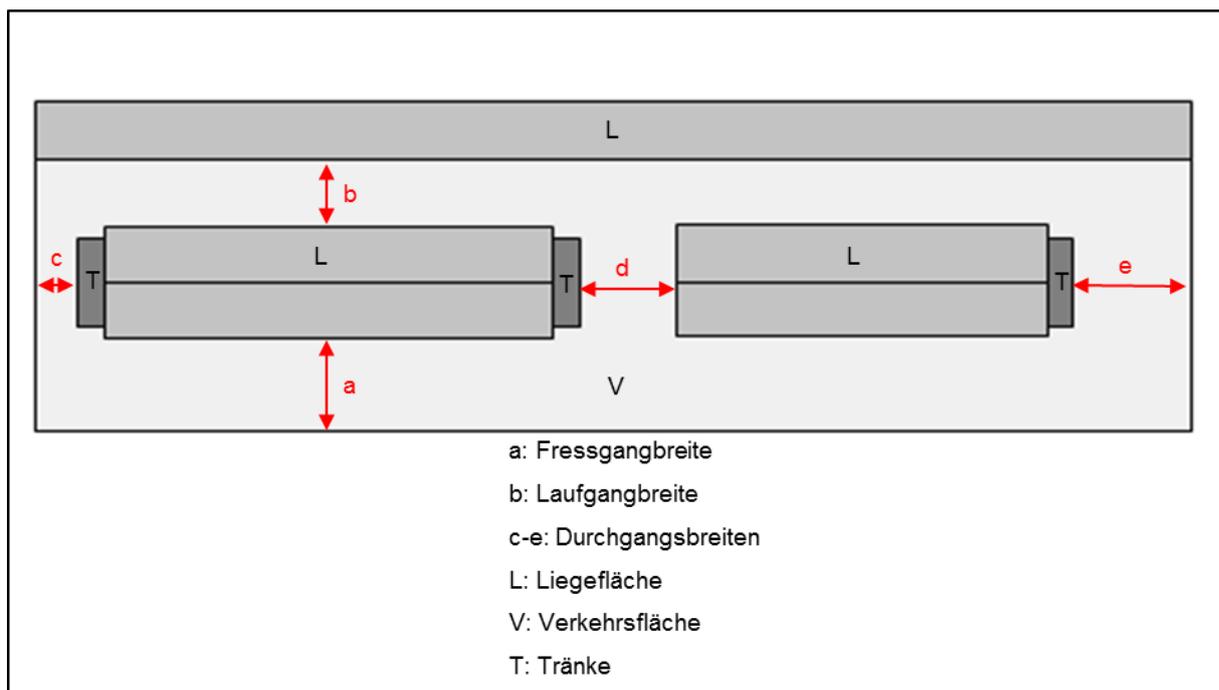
Grundriss eines Stallabteils. Gangbreiten und Durchgänge sowie Flächen am Beispiel eines Stallabteils mit drei Reihen Liegeboxen
